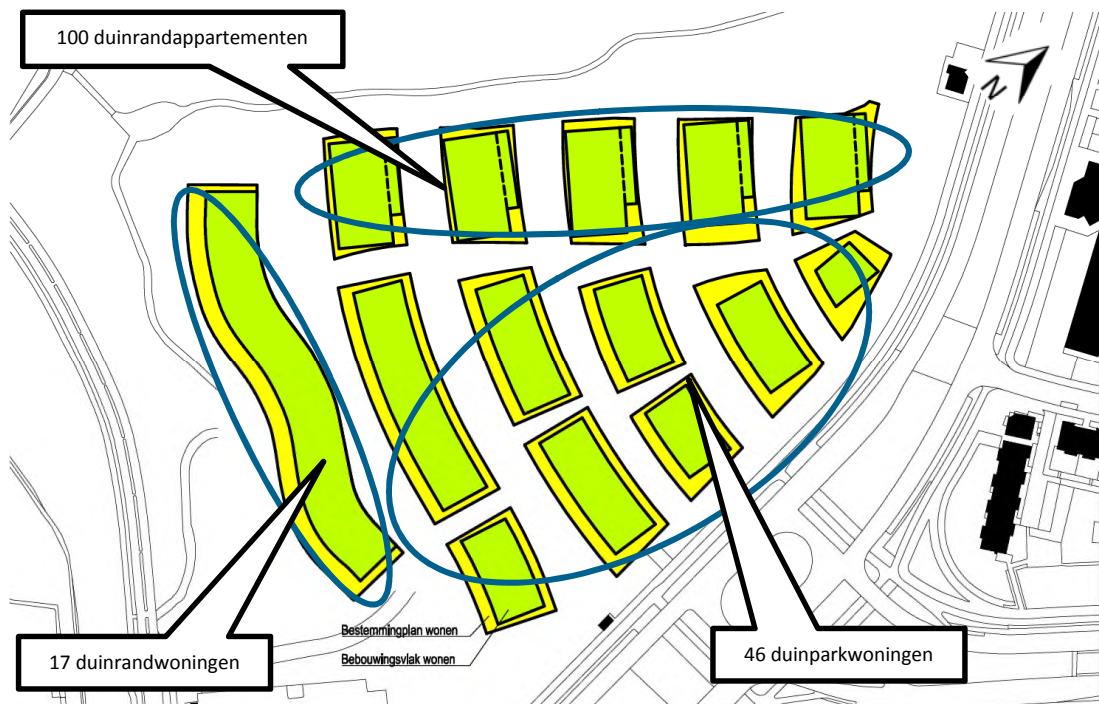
Detaillering plangebied woningbouw Waldeck op luchtfoto (Bron: Ruimtelijkeplannen.nl).
